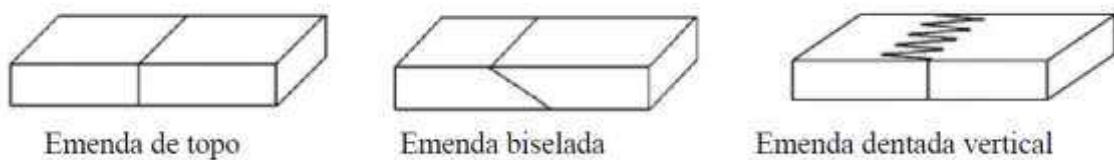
Tipos de emendas utilizadas na fabricação da madeira laminada colada (TELES,2009).
